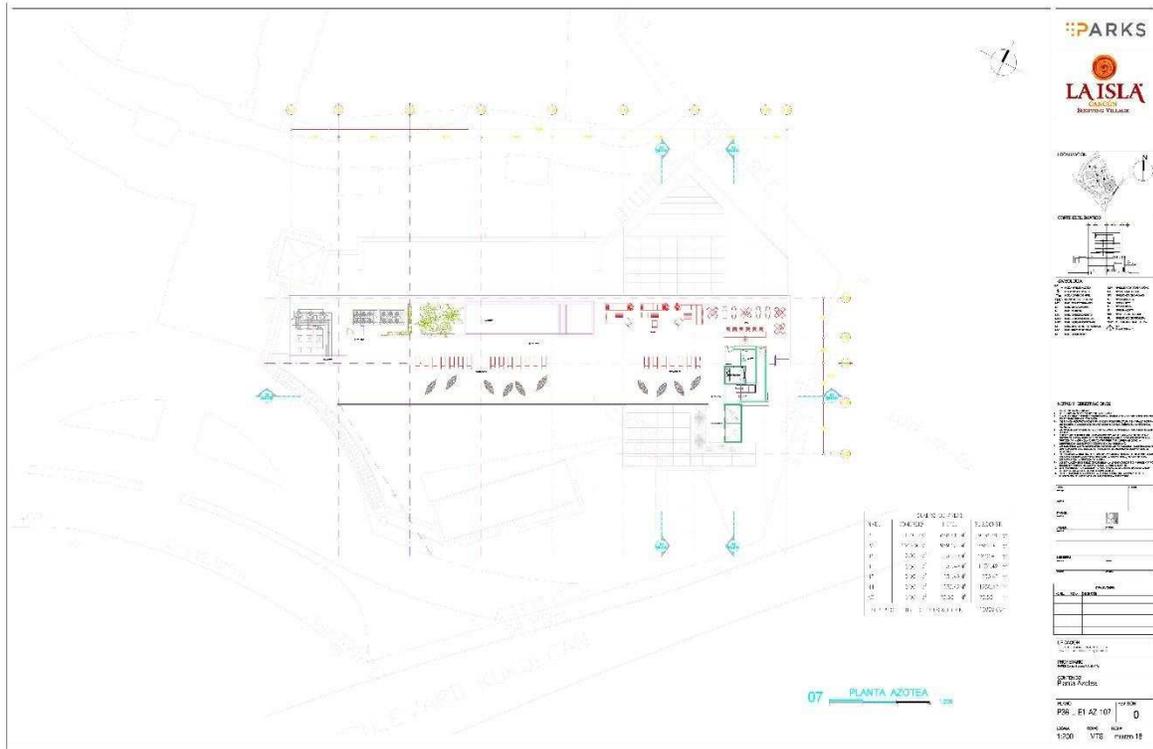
Planta de conjunto del Hotel La Isla Cancún mostrando el arreglo de instalaciones en la azotea, que incluyen además del equipamiento una alberca, asoleadero y un bar al aire libre. Fuente: Promovente.
